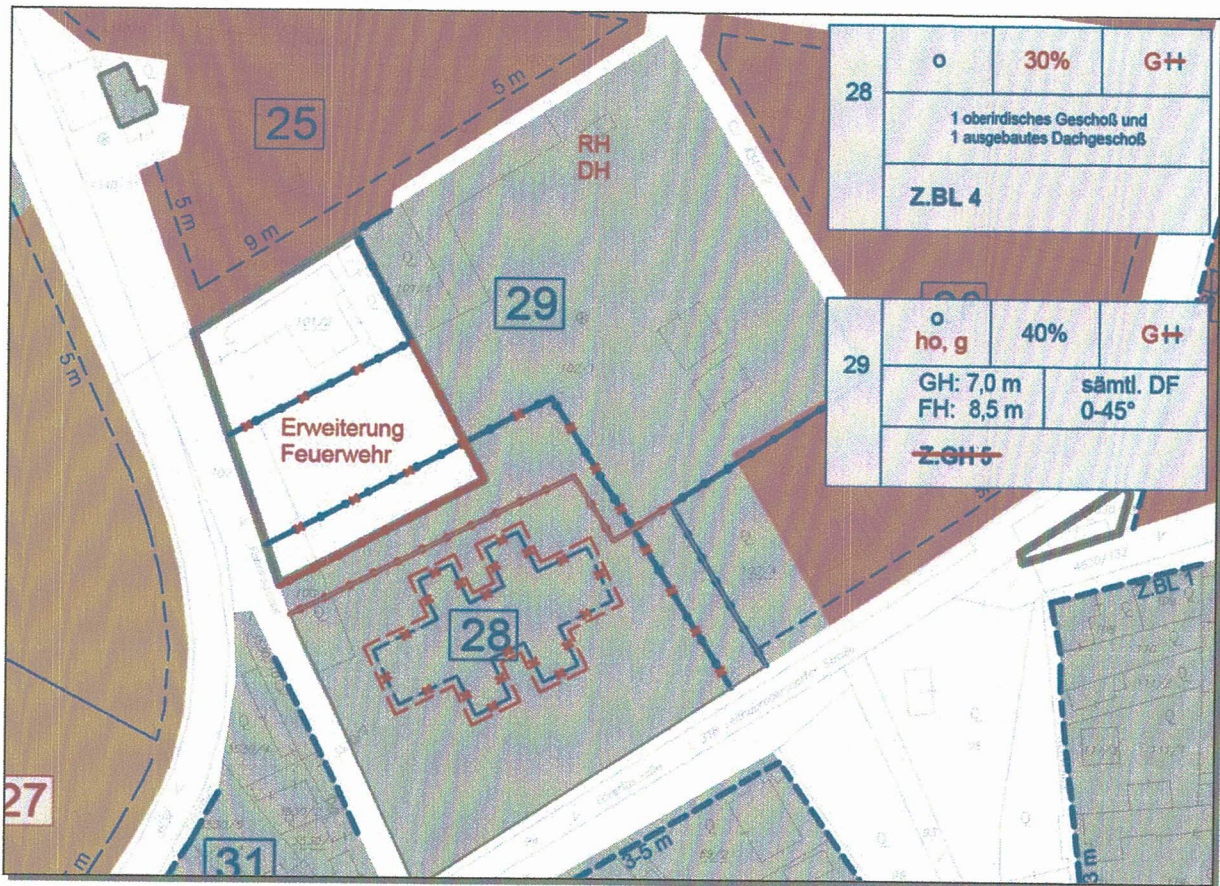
Auszug aus Bebauungsplan 2021 – Entwurf – für den Bereich Kreuzscheune. Die vorgesehenen Bauungsbestimmungen wurden einkopiert
